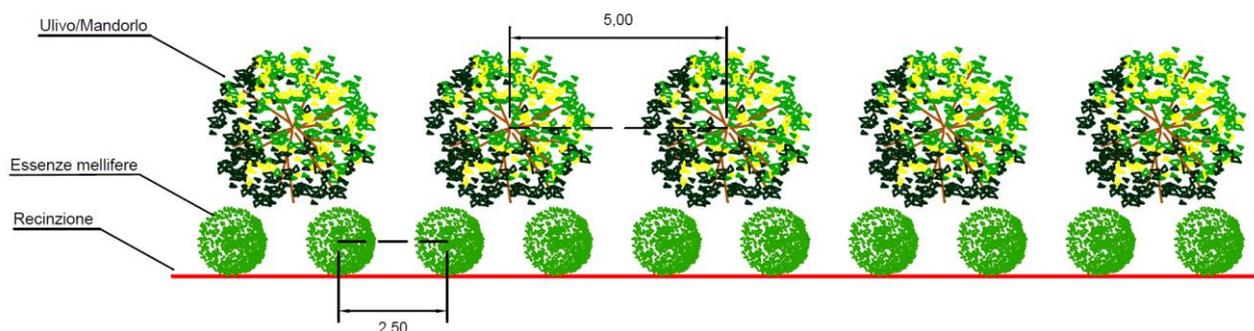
Fascia di mitigazione - schema in pianta del sesto di impianto
